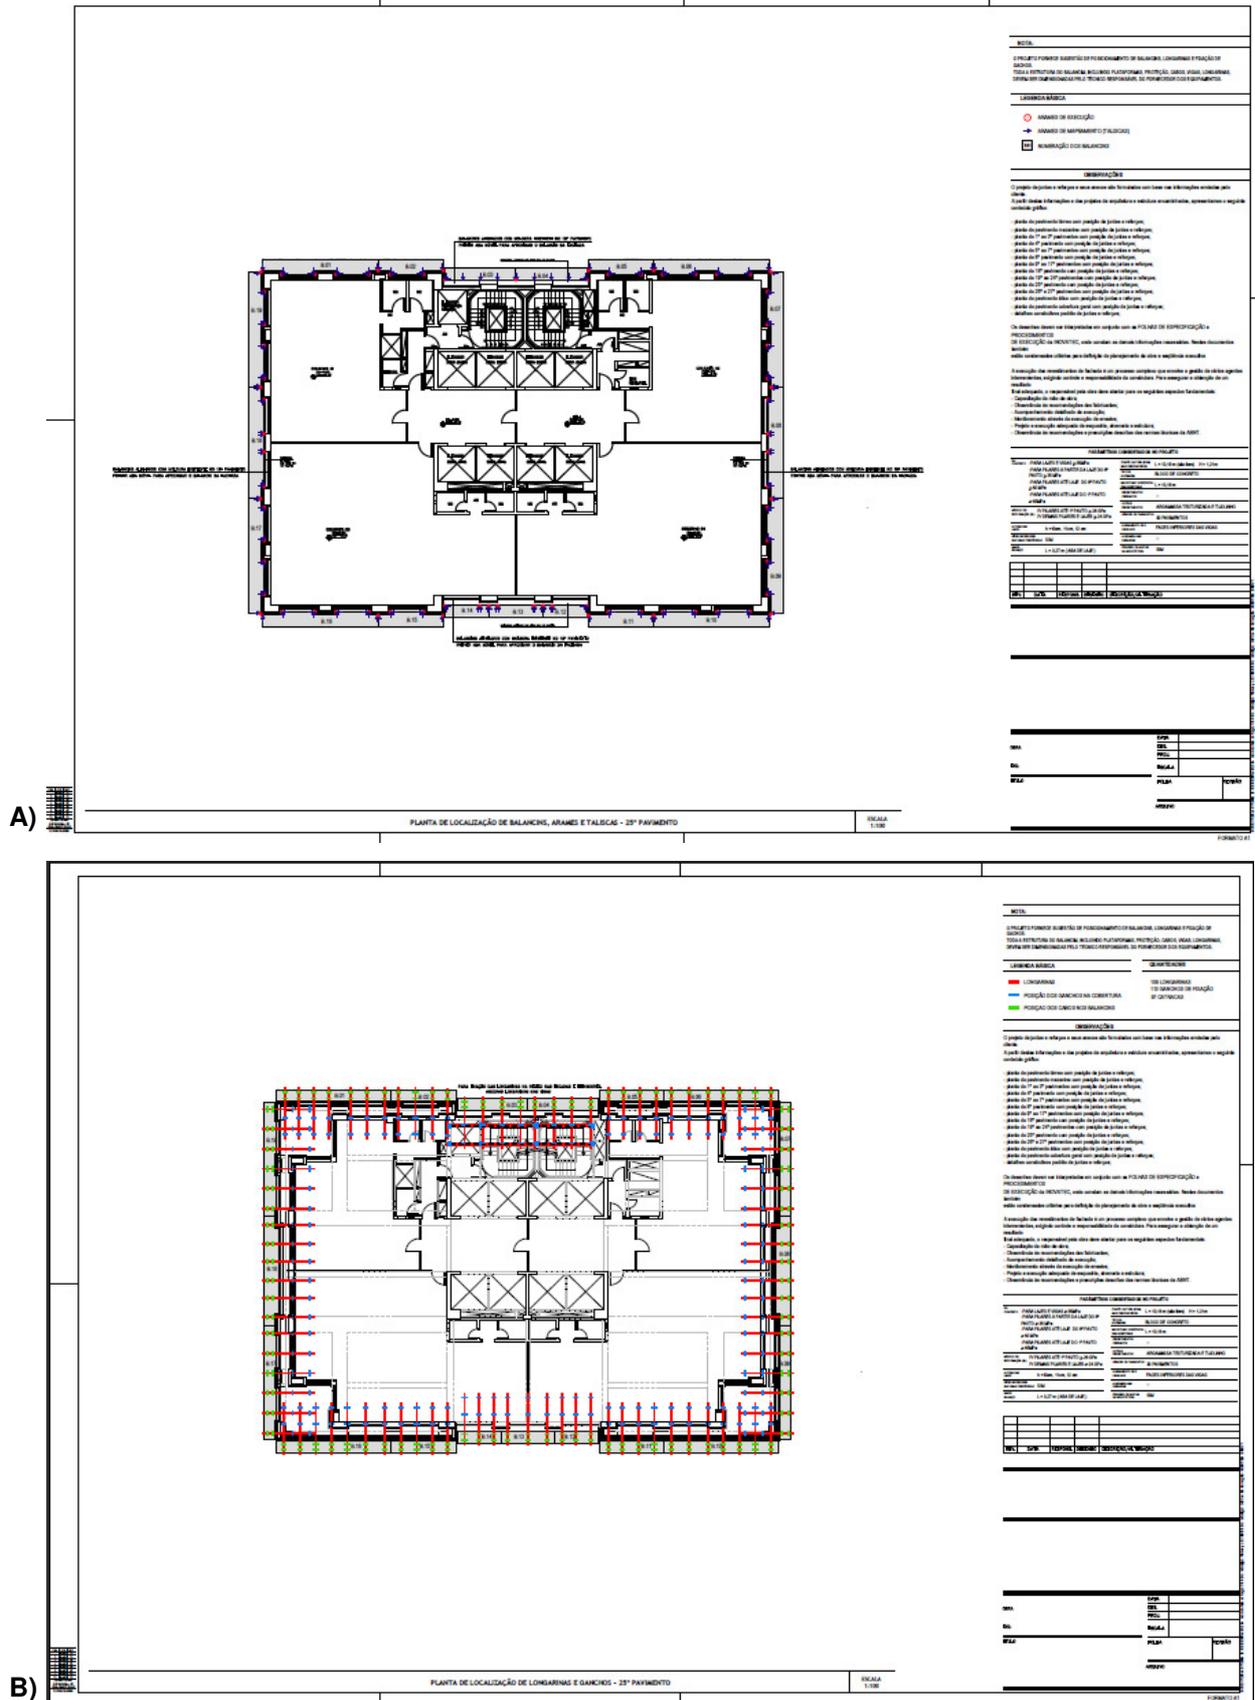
Pranchas do PRF para Torres Residenciais e Comerciais. A) Planta de balancim; B) Planta de longarina.
